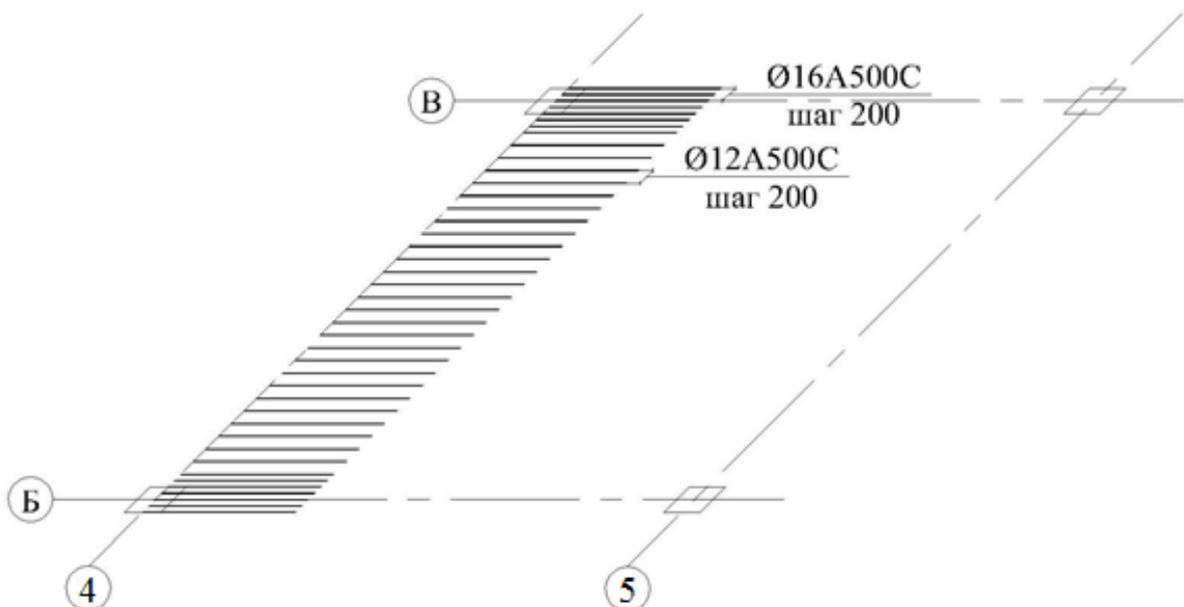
План раскладки дополнительной арматуры на опорах
